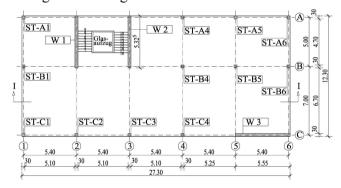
Grundriss im Regelgeschoss
